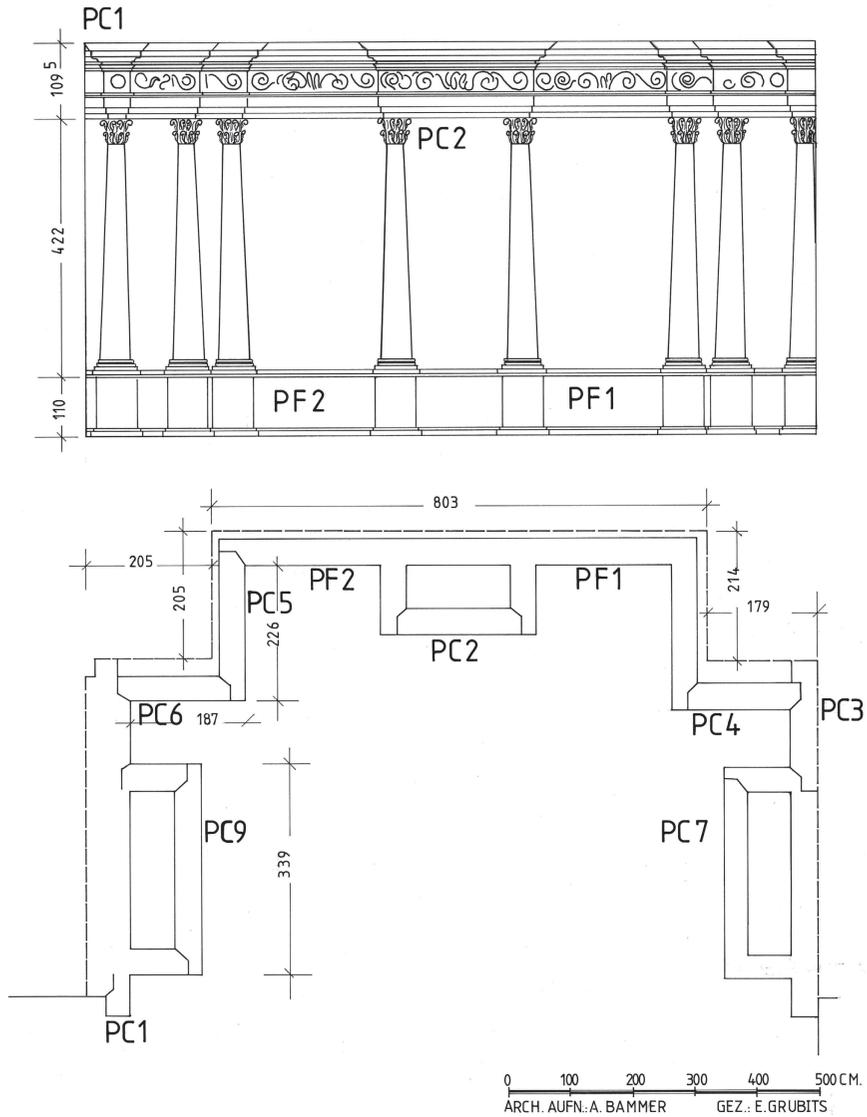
Grundriss des Pollio-Bau, Zeichnung: A. Bammer, ÖAI-ÖAW AT-OeAI-99-00187151
